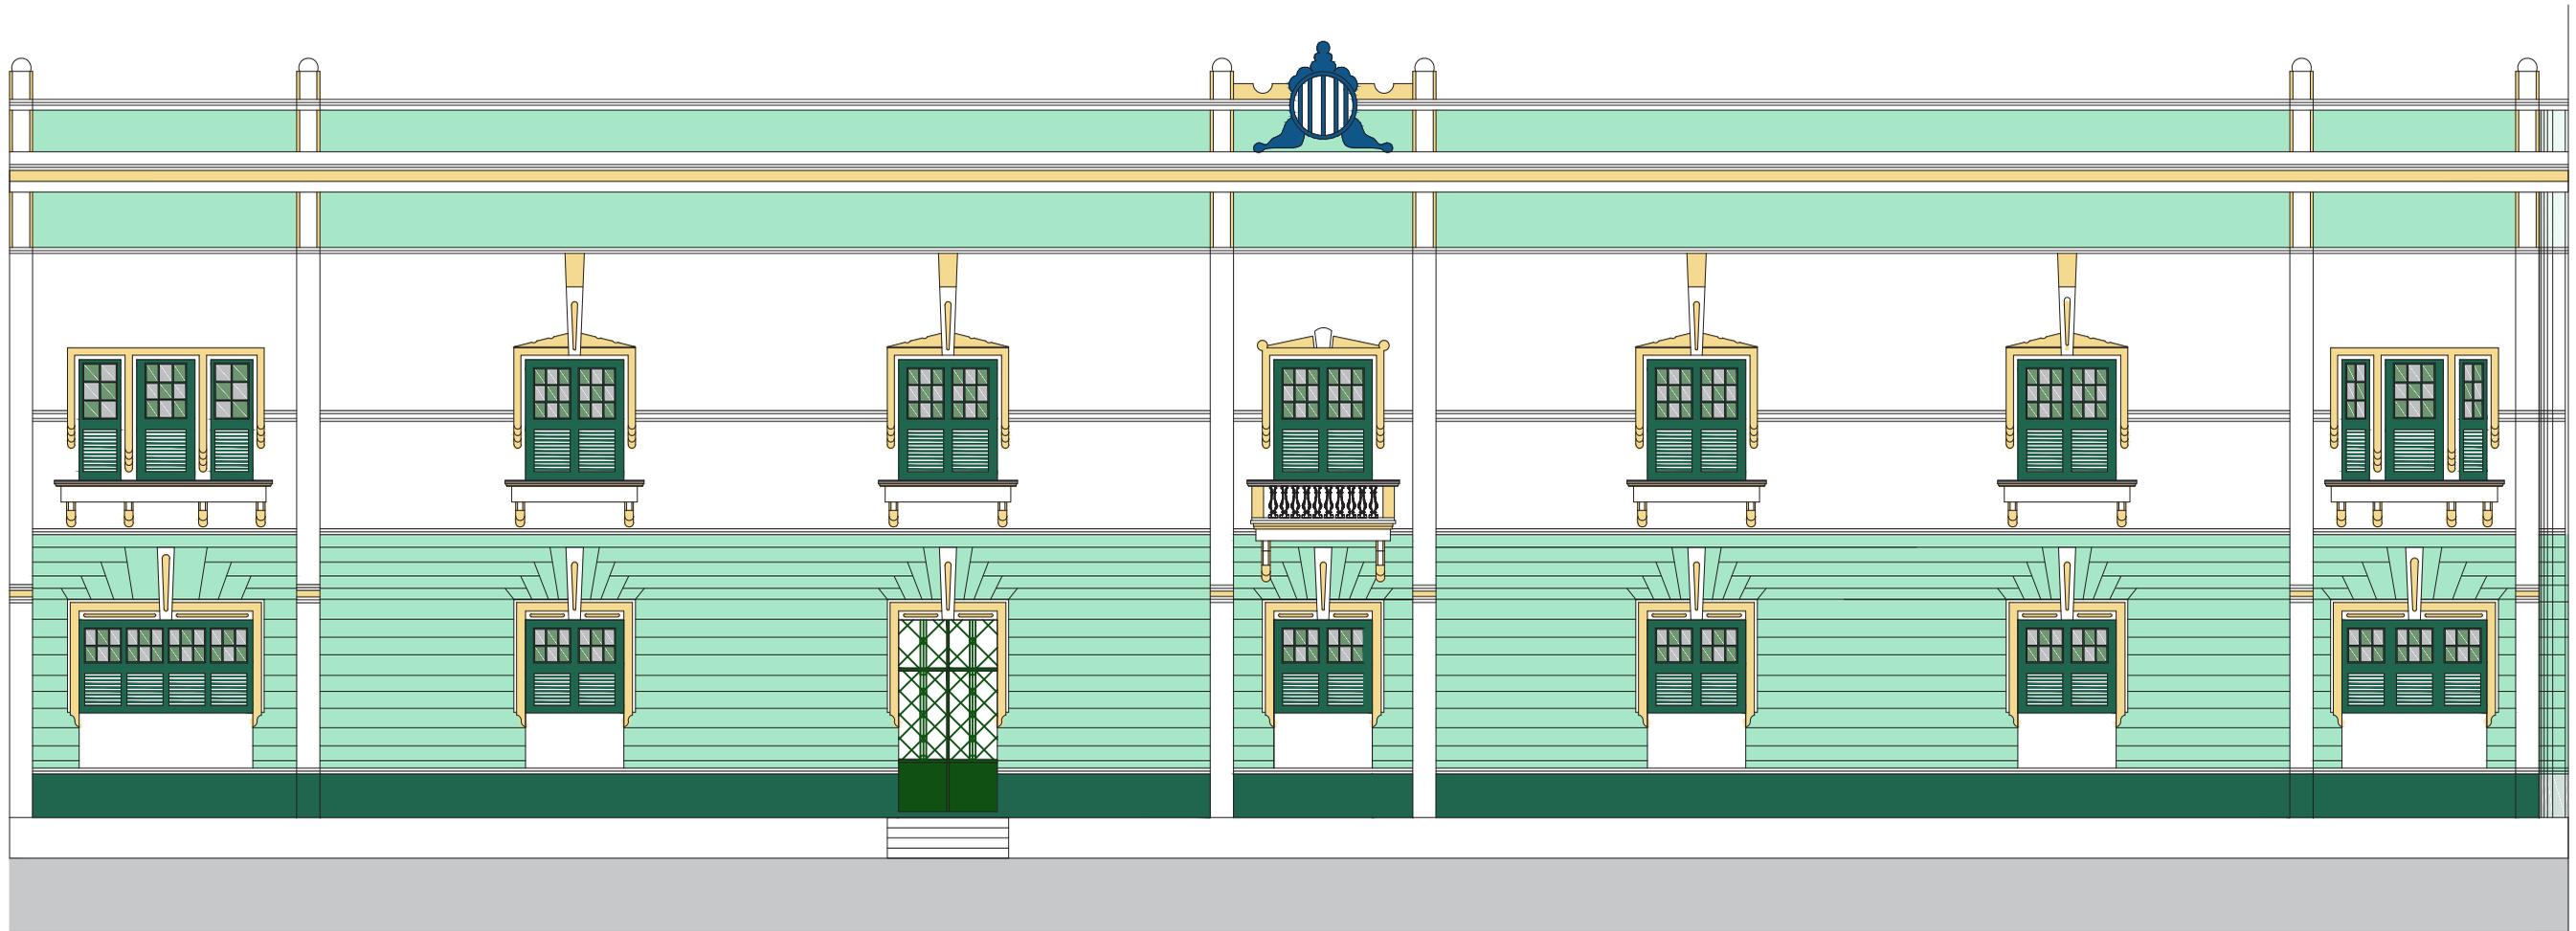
Fachada Norte com elementos do estilo arquitetônico eclético. Fonte: SEINF – Sefaz/Ce (modificado).
